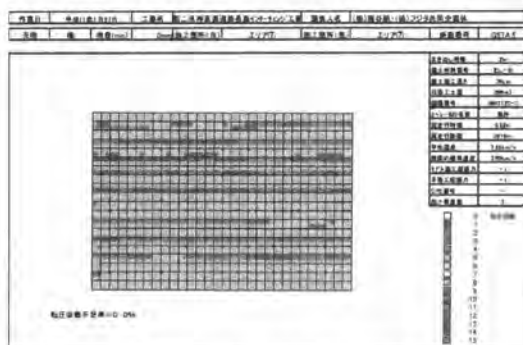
システムによる施工の転圧回数色分図 図-7 オペレータによる目視施工の転圧回数色分図
